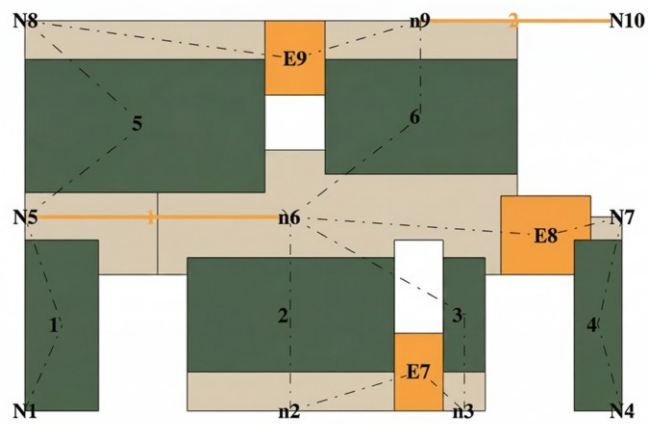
Prospetto Parete 1 - Modello Isolato
